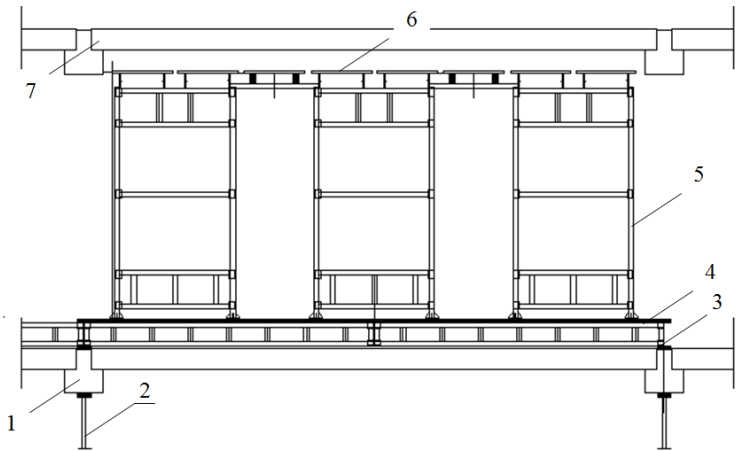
Схема розташування підтримуючих пристосувань на поверхсі будівлі під плиту, що підлягає руйнуванню: 1 – ригель; 2 – стійка; 3 - дошка з перерізом 150x40 мм; 4 – настил з металевих балок та дощок 120x40 мм; 5 – збірно-розбірна тумба; 6 – щити; 7 – плита, що розбирається
